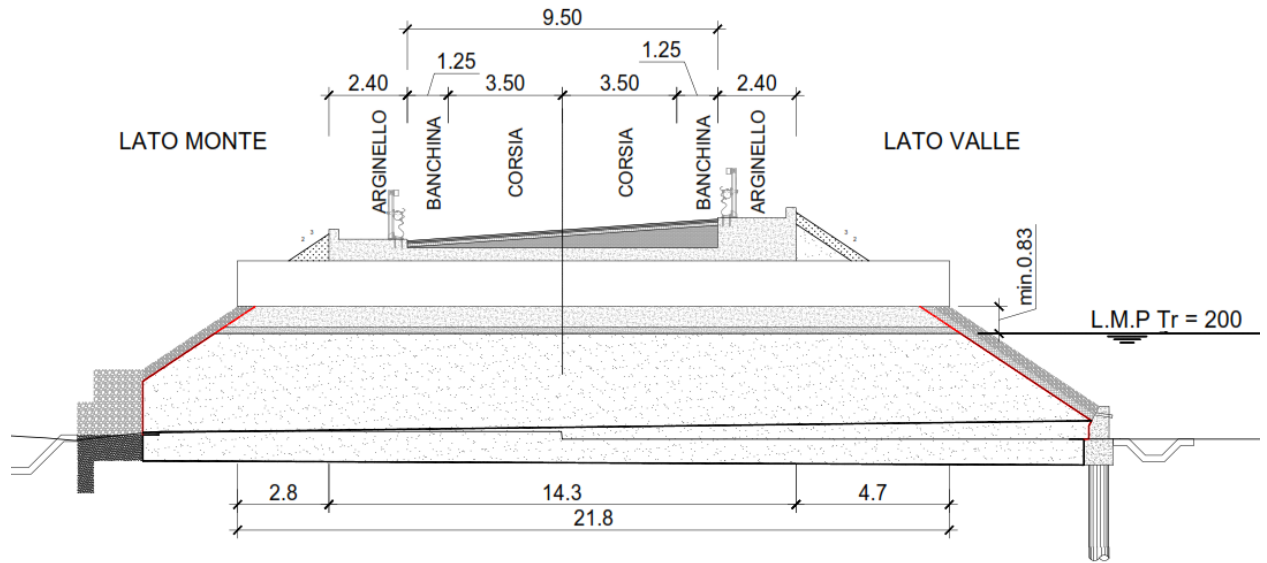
Sezione trasversale tipo del manufatto di attraversamento idraulico.
